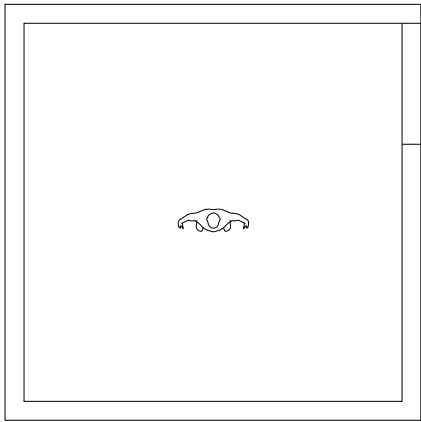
Pos. VI* | *Grundriss – M.1:100
